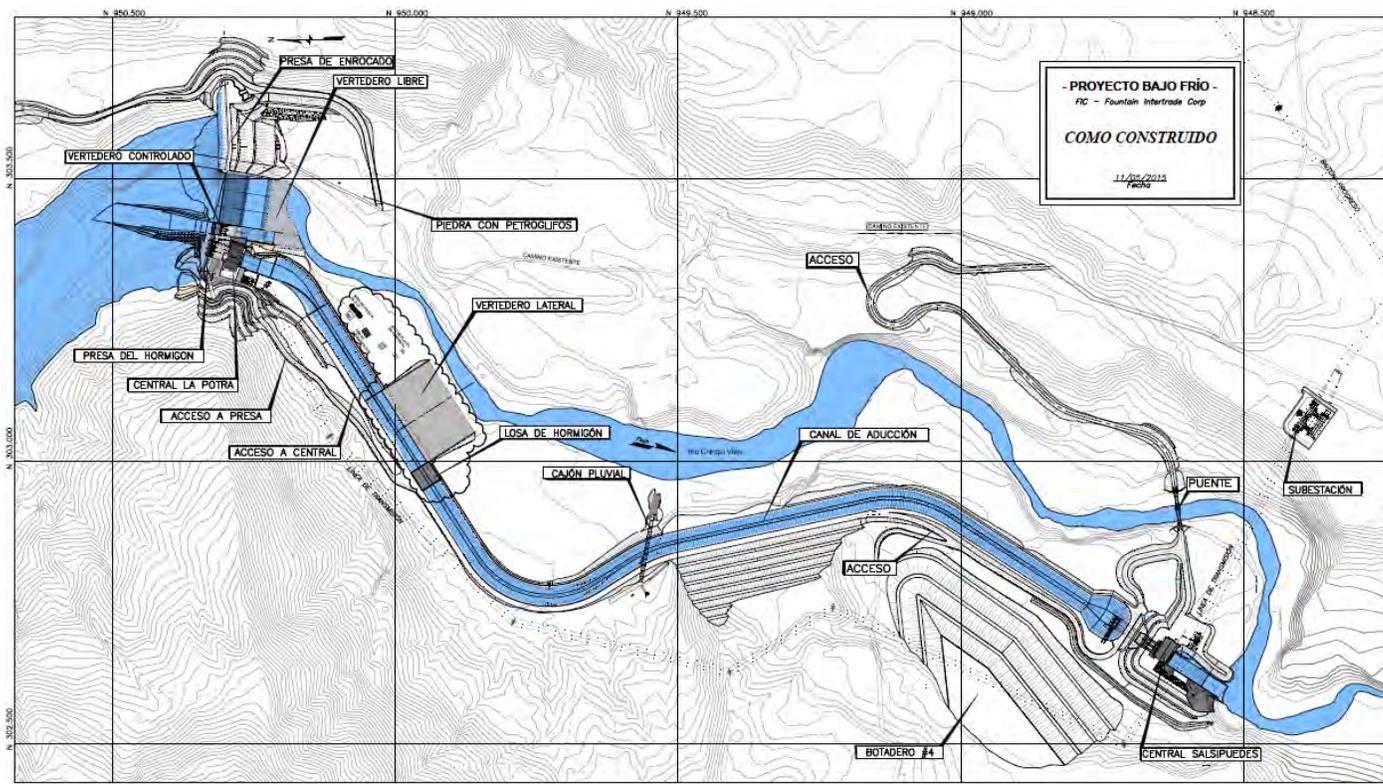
Planta General de la Central Hidroeléctrica Bajo Frío
